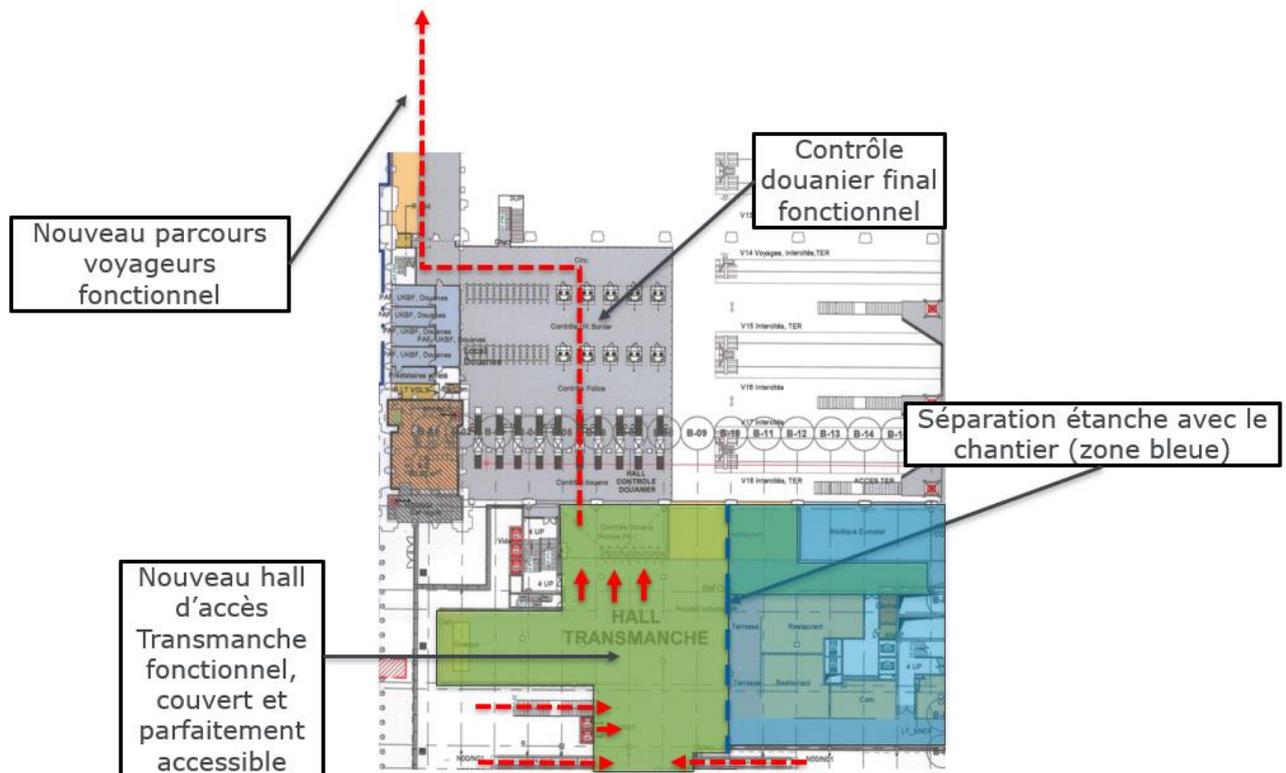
Plan des dispositions provisoires pour l'accueil du public au niveau du terminal Transmanche lors de la coupe du monde de rugby de 2023
